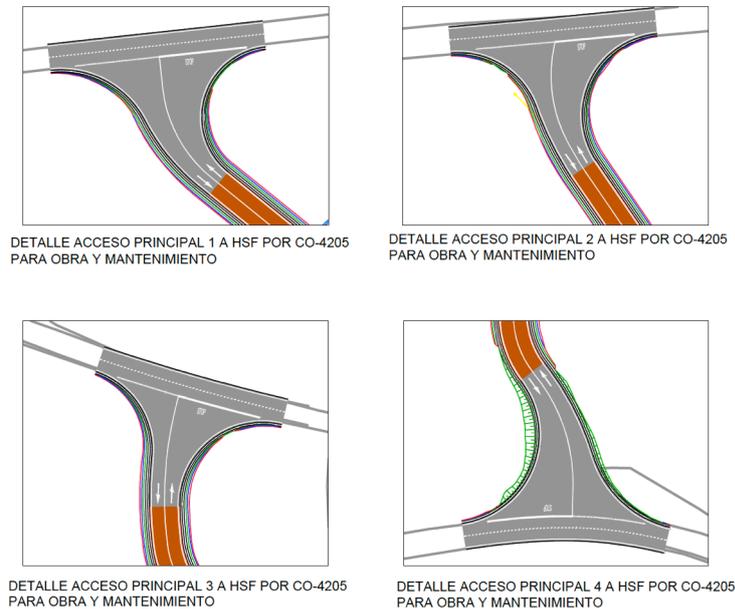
Accesos a la Planta Solar Fotovoltaica (Detalle).
